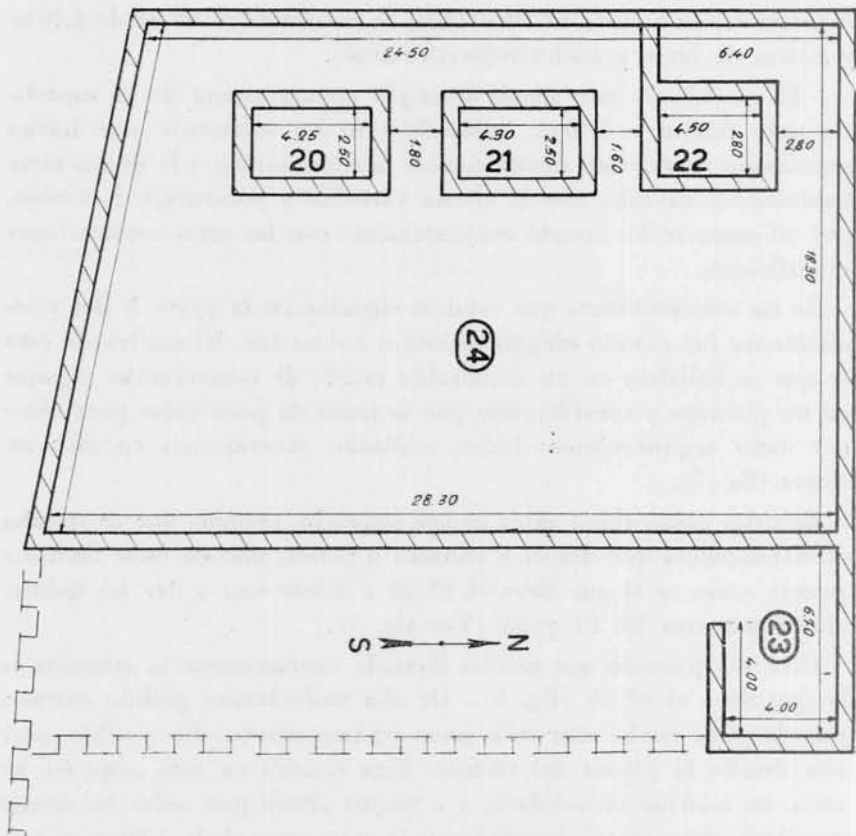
Planta y dimensiones del núcleo nos 20 a 24
